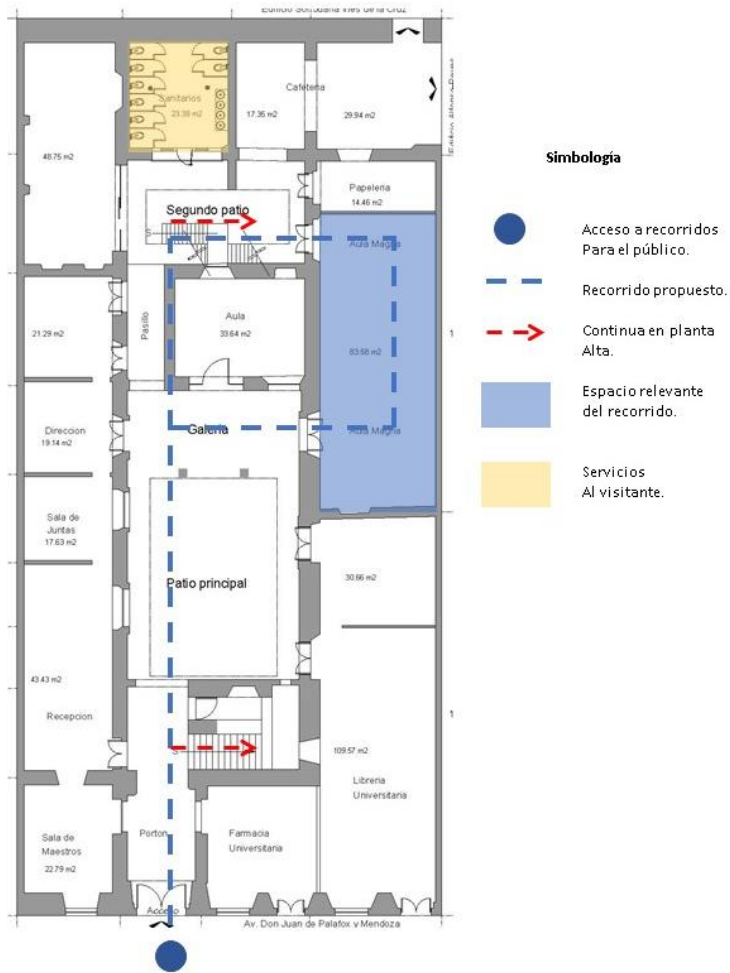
Propuesta de recorrido al público en general en Planta Baja.
